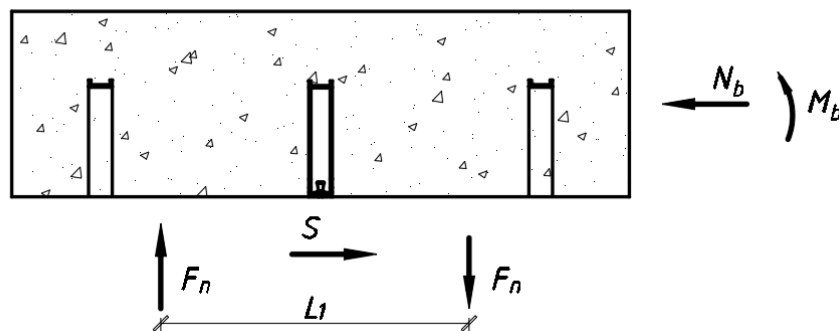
Распределение усилий в бетонной части сталежелезобетонного перекрытия
